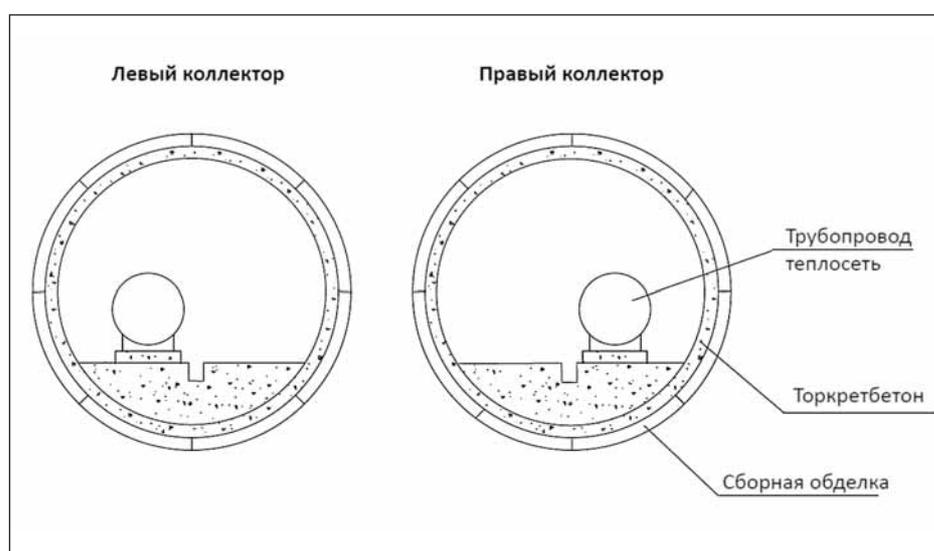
Схема конструкции двухслойной тоннельной обделки коллекторов тепловой сети
